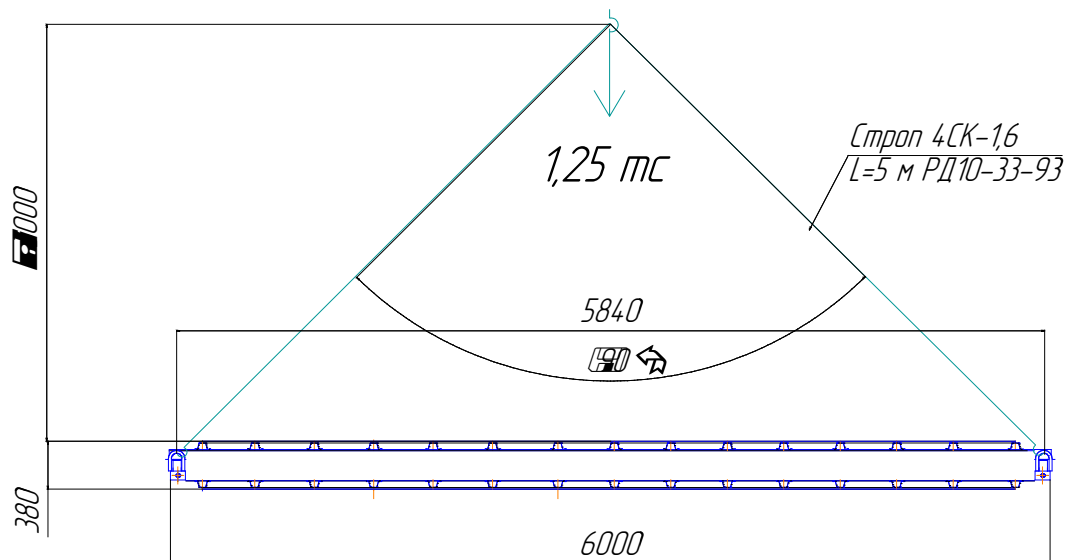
Схема строповки панели основания (перекрытия, покрытия)
